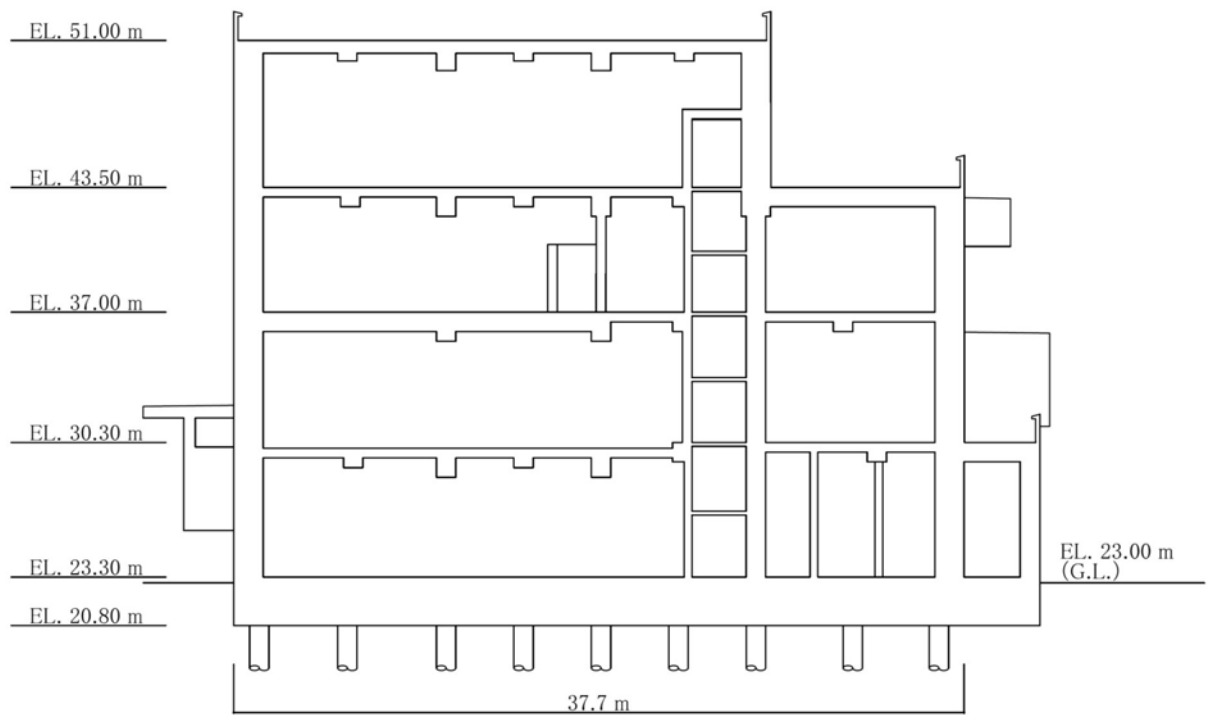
(1/2) 緊急時対策所建屋の概略断面図 (A-A 断面)
